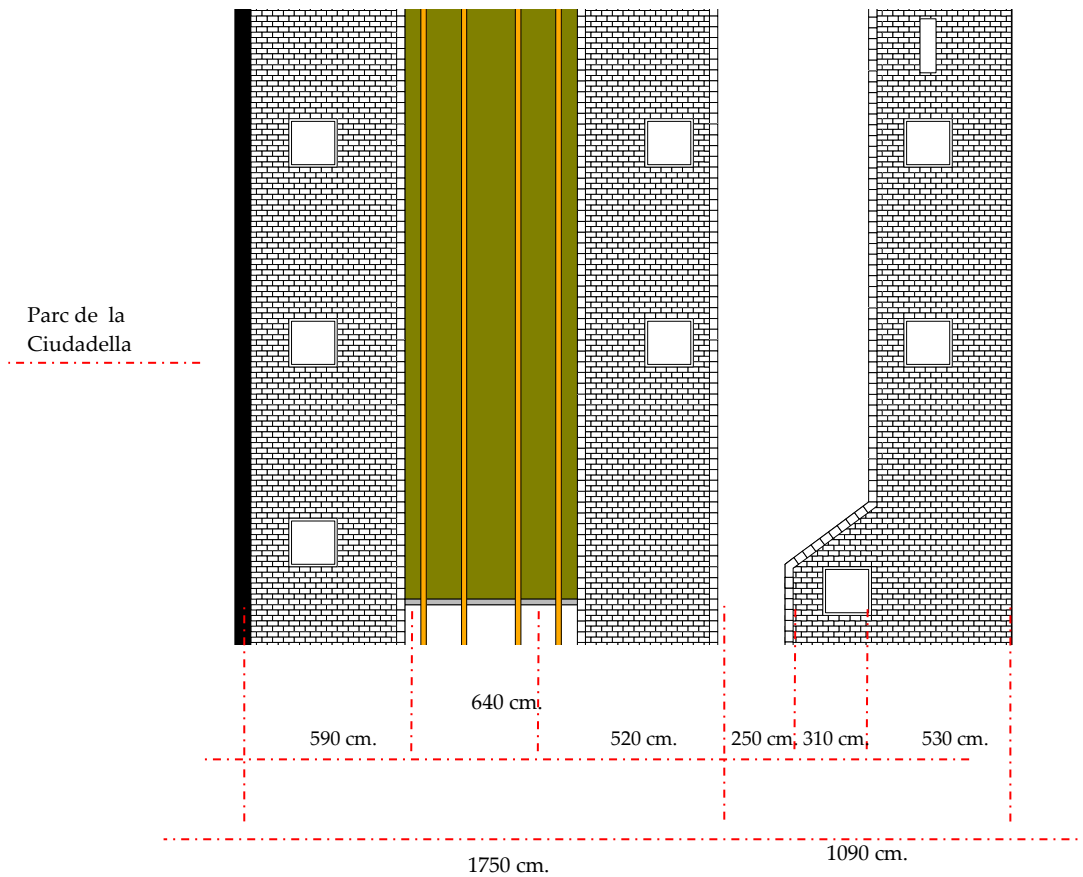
Planta de detalle A. Fuente: elaboración propia.
